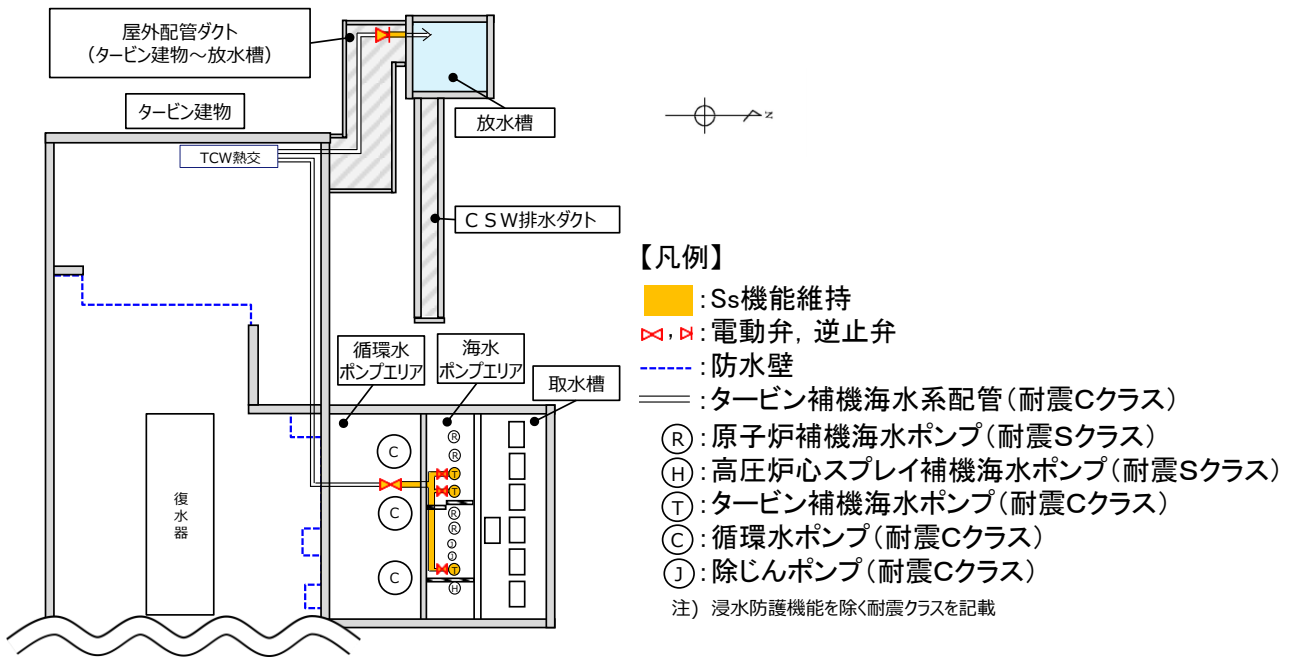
タービン補機海水系の対策概要 (平面図)
